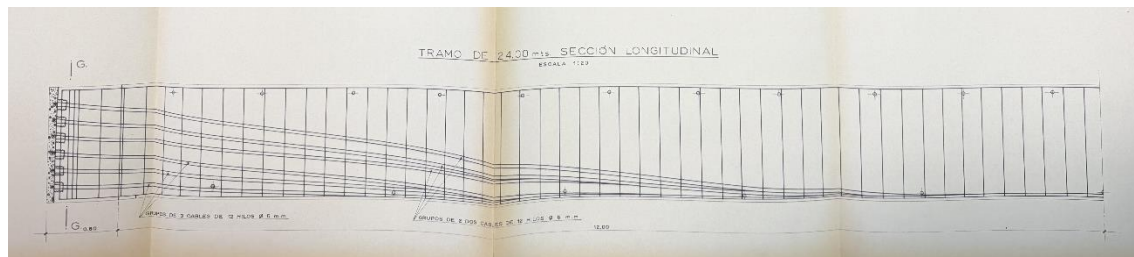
Sección longitudinal de las vigas sobre ff.cc. Fuente: [7]
